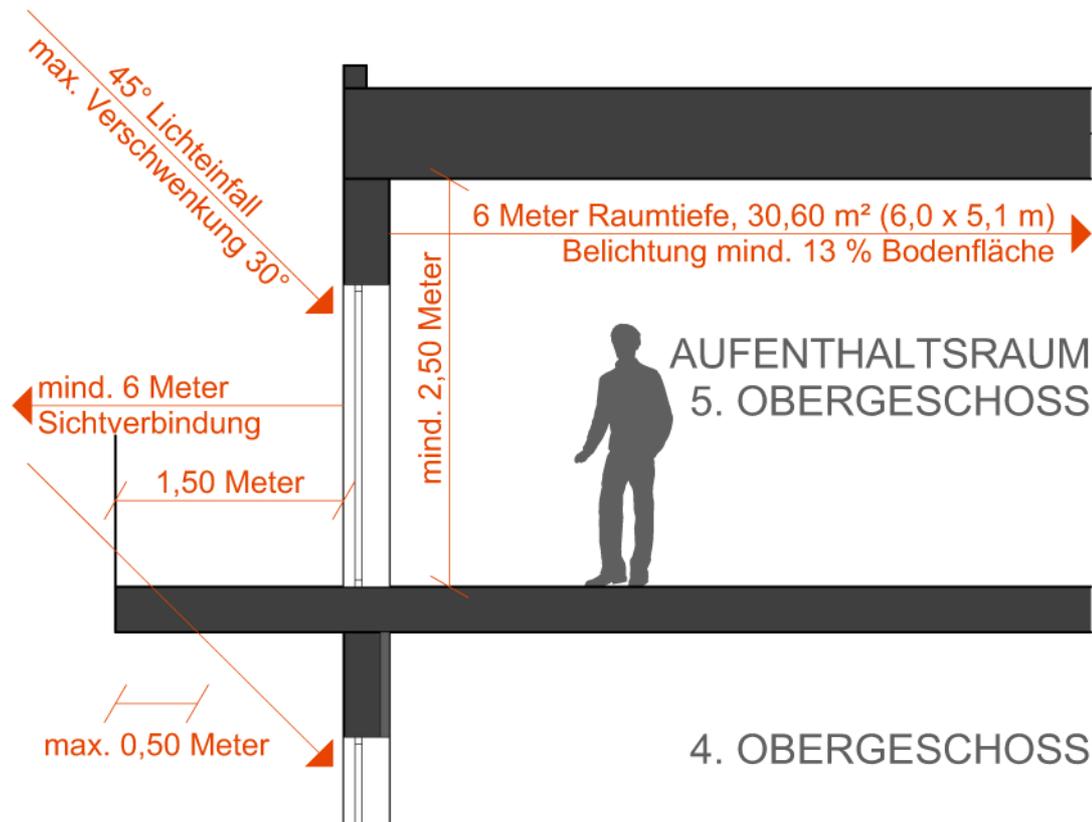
Bauteilausschnitt: Lichte Höhe und Belichtung 1:50
